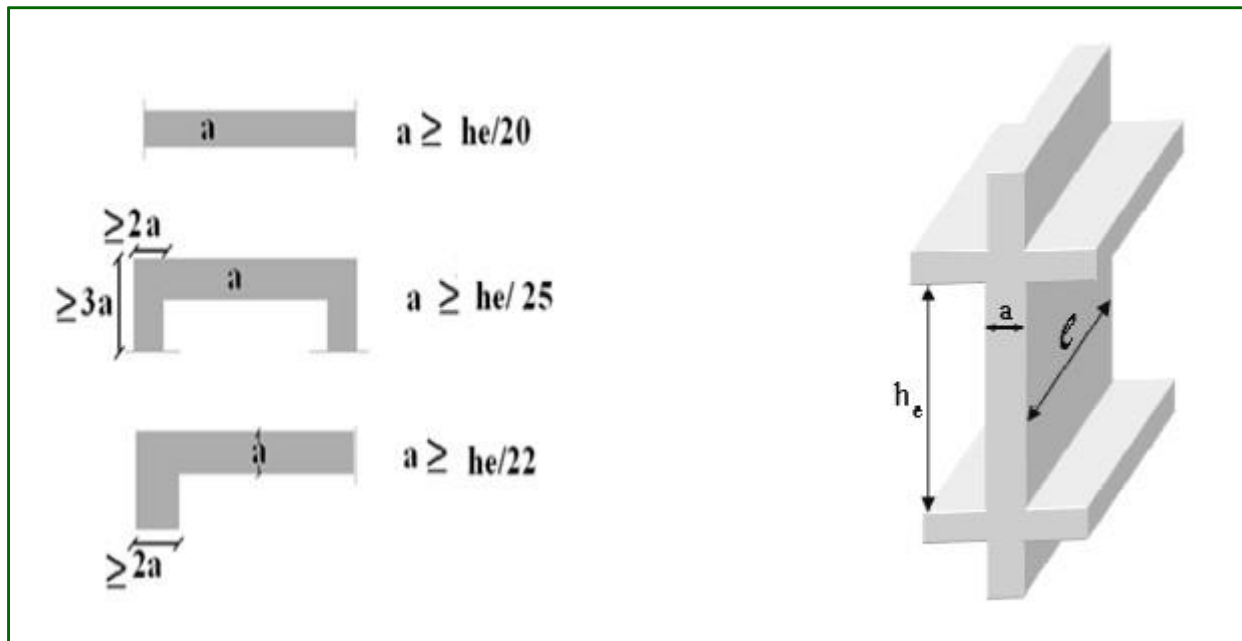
Coupe de voile en plan (gauche), Voile en 3D (droite)
